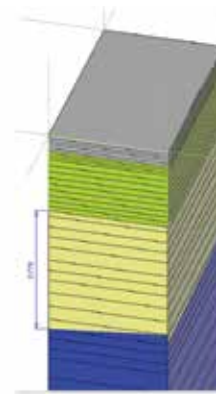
Глубина оттаивания грунта при устройстве асфальтового покрытия без теплоизоляции
